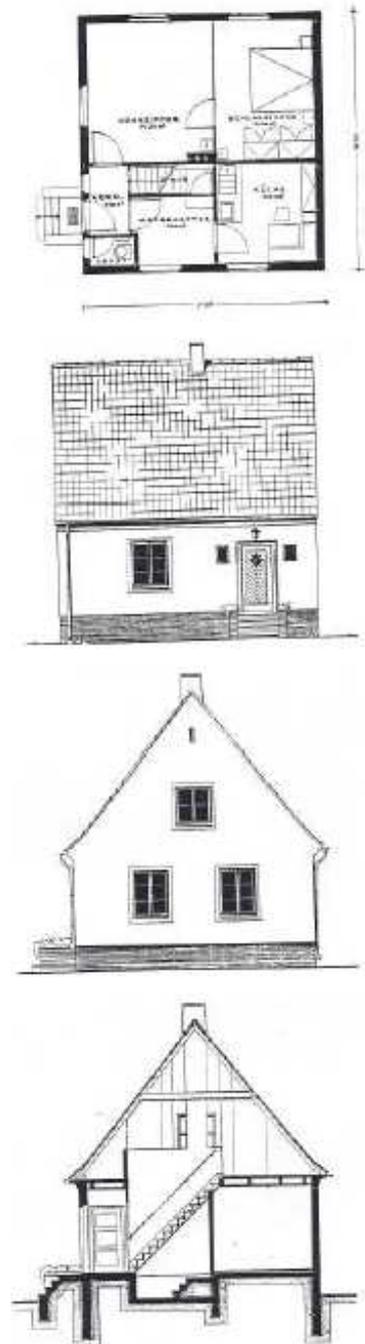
Ansichten, Grundriss Erdgeschoss und Schnitt Siedlerhaus³⁴
